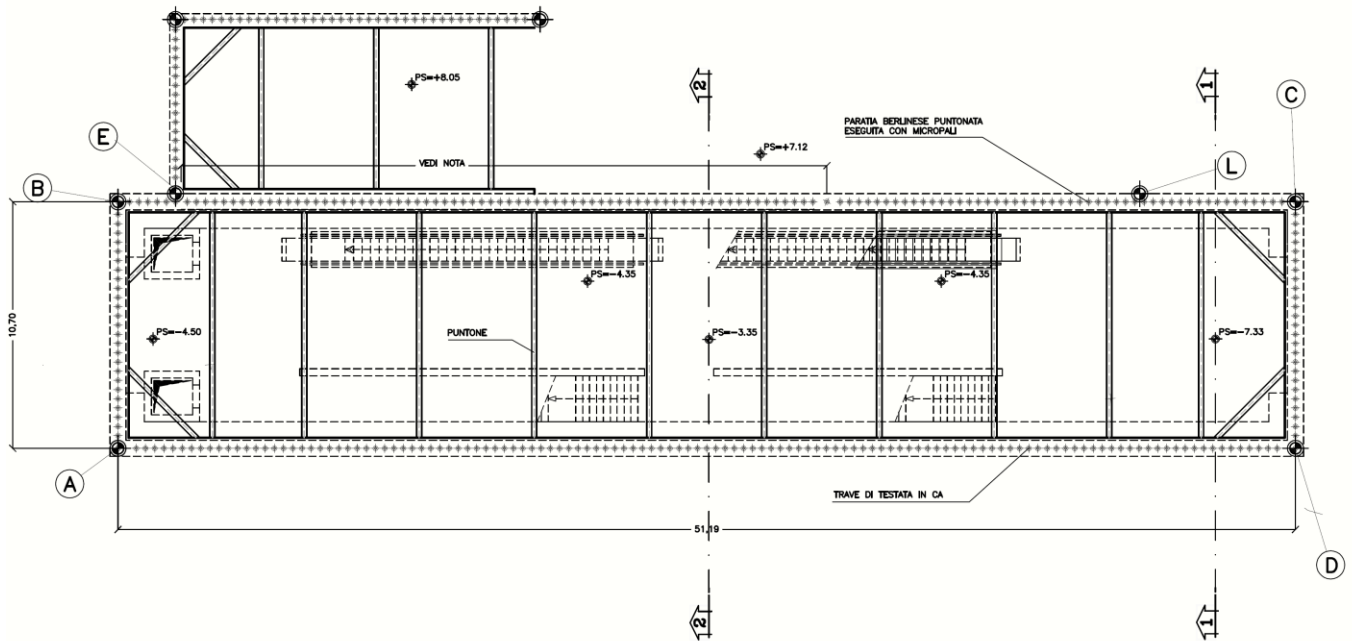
Planimetria con indicazione delle sezioni di calcolo
